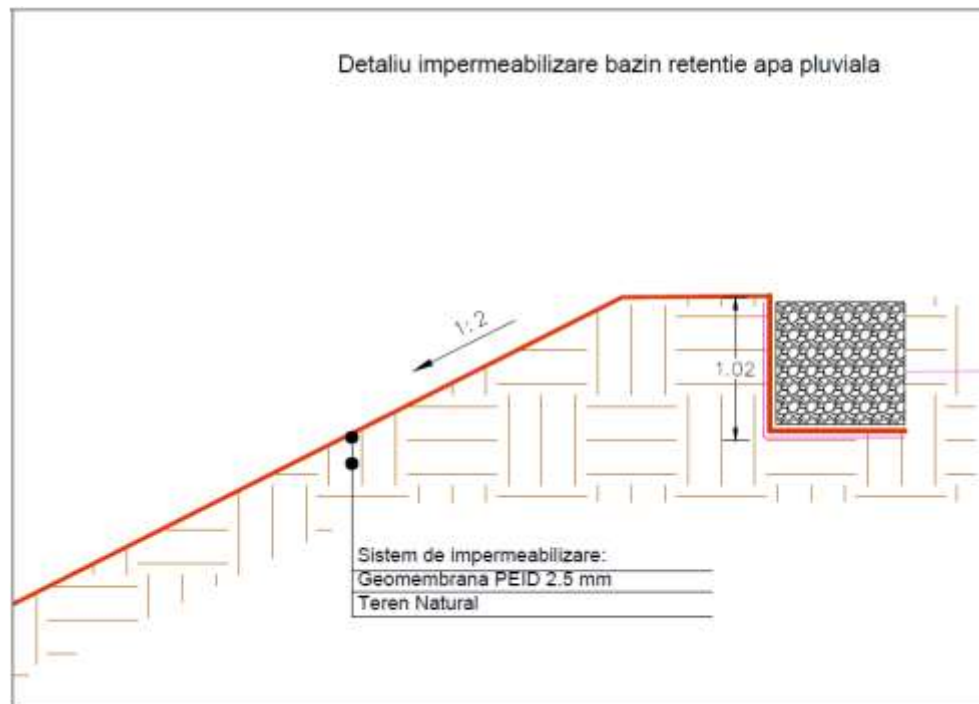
Sistem impermeabilizare bazine retenție ape pluviale
